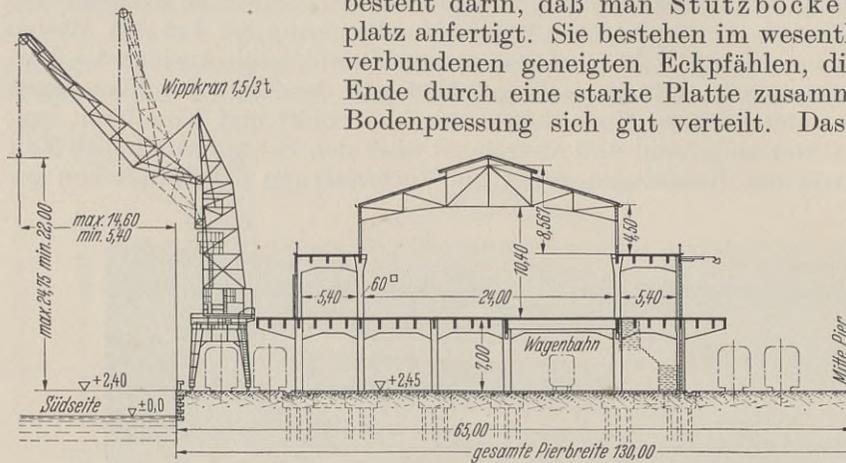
Kaischuppen 14. Mischbauweise Eisenbeton und Stahlfachwerk.
